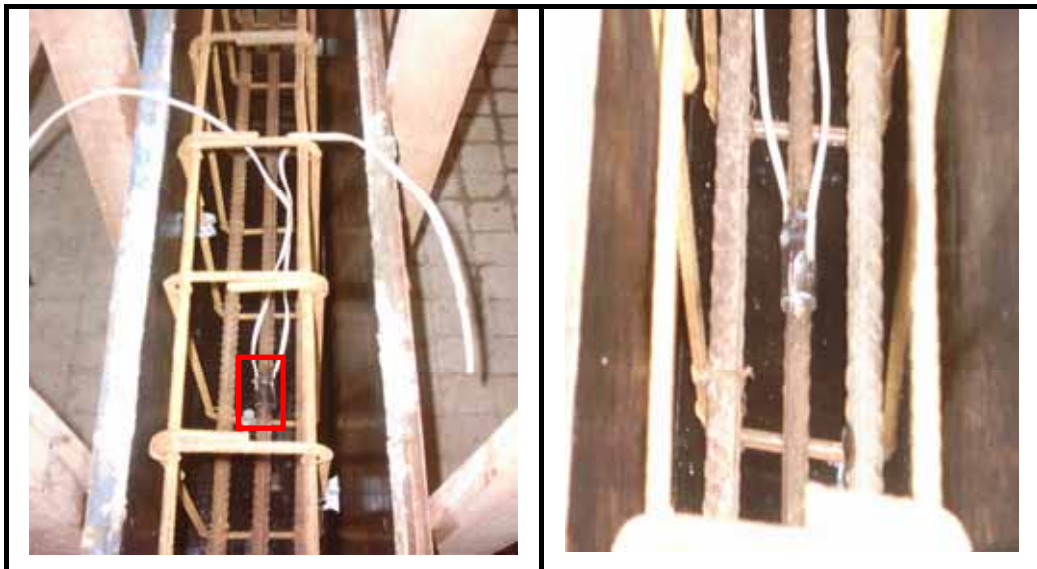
Extensômetros colados nas barras de aço das vigas REF1, REF2, V1R e V2R.
